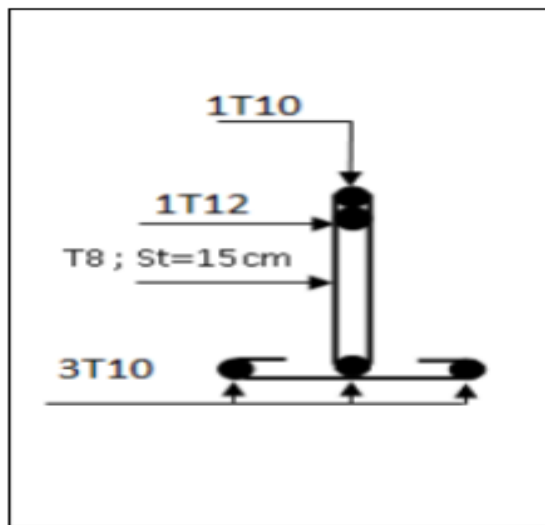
Schéma de ferrailage des nervures "plancher terrasse".
